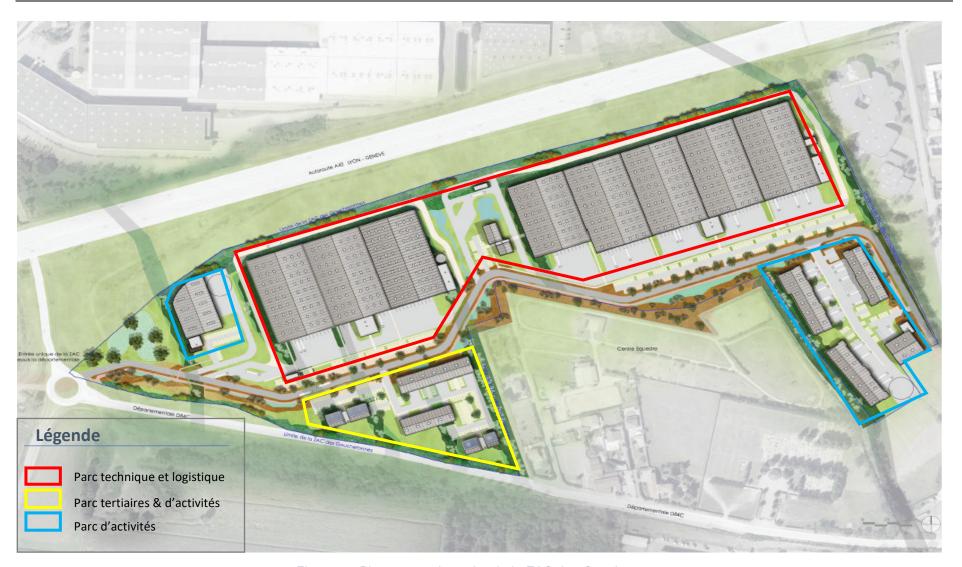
Plan masse du projet de la ZAC des Goucheronnes
